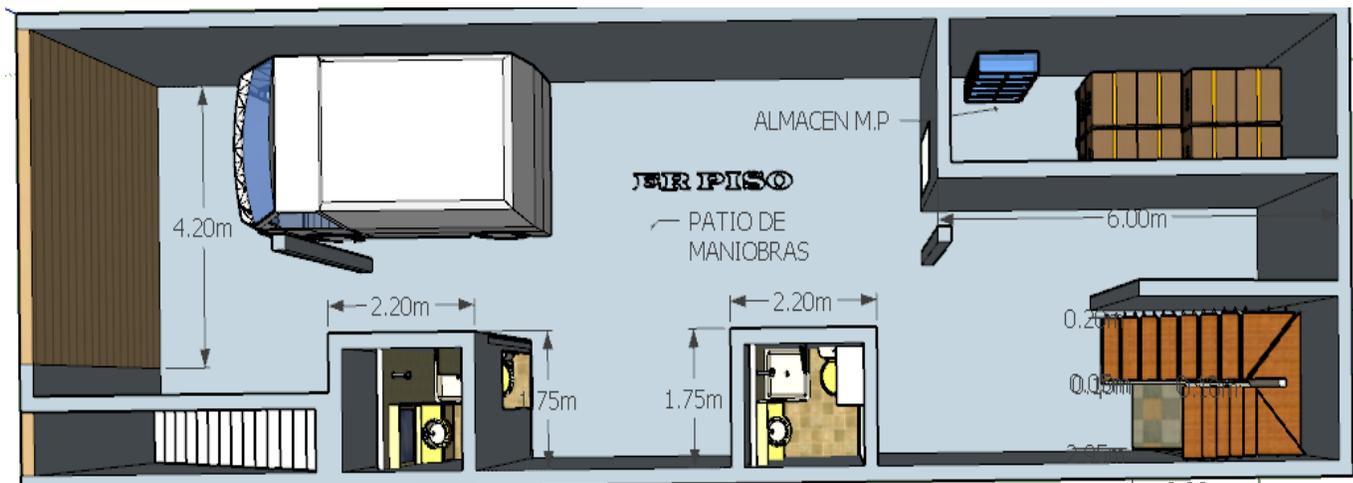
Plano primera planta de "Multiservicios Caladri S.A.C"
